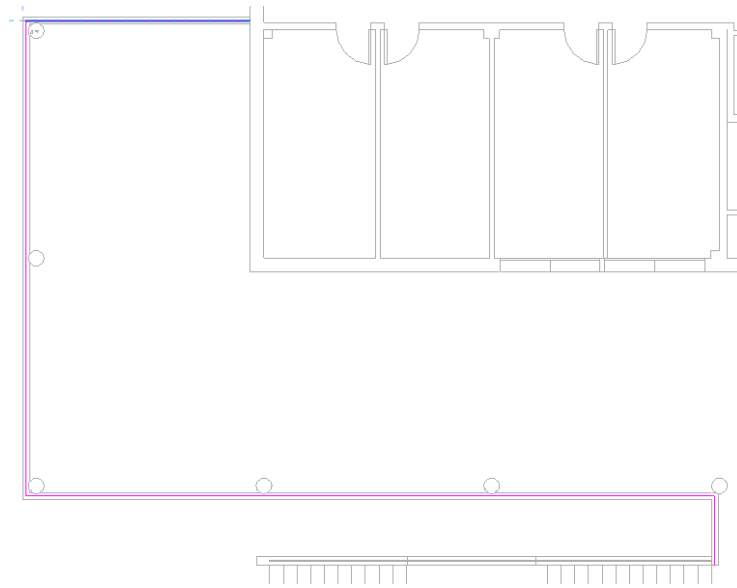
Dibujo de tramo de barandilla de la parte exterior
